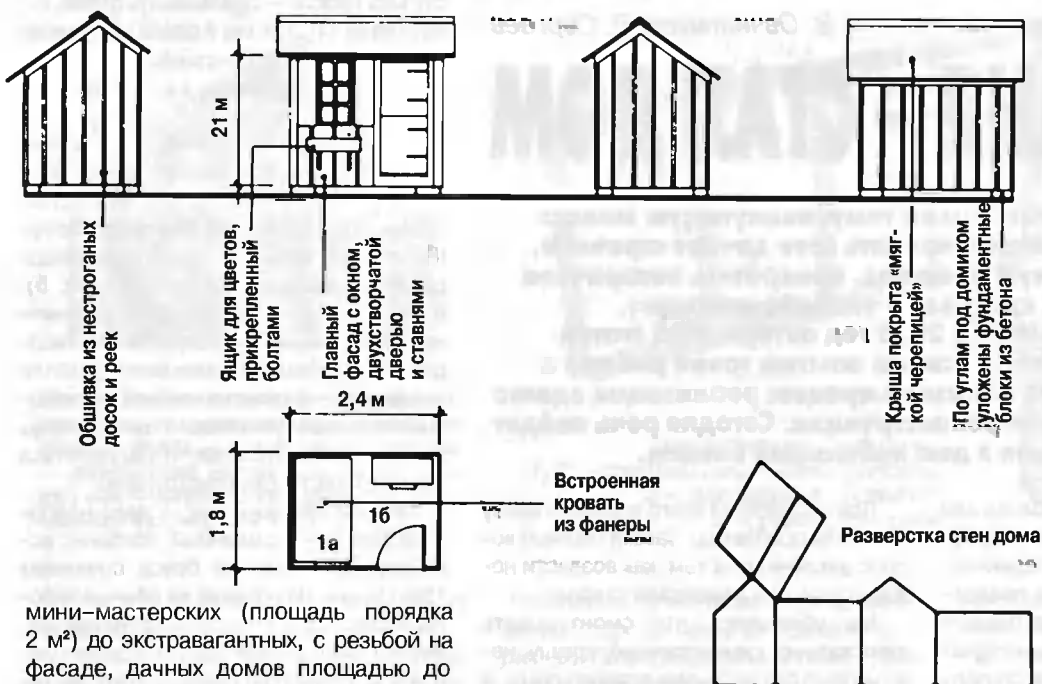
Фасады, план и развертка деталей сборочного комплекта
